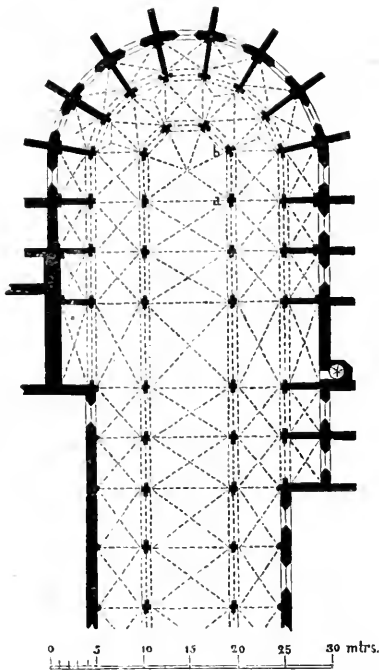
Kirche zu Zwettl. Grundriss.
